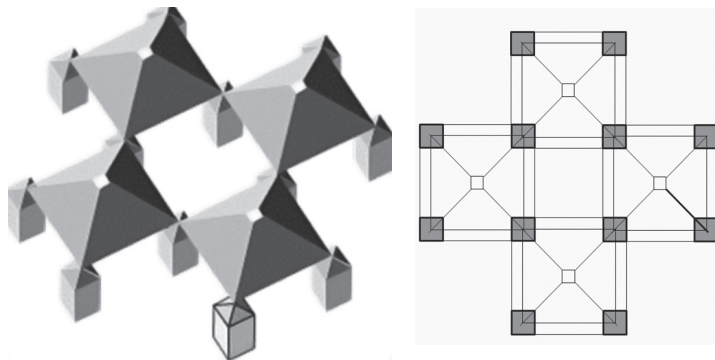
Baños de Treton. Las columnas huecas contienen los servicios. Fuente: elaboración propia
